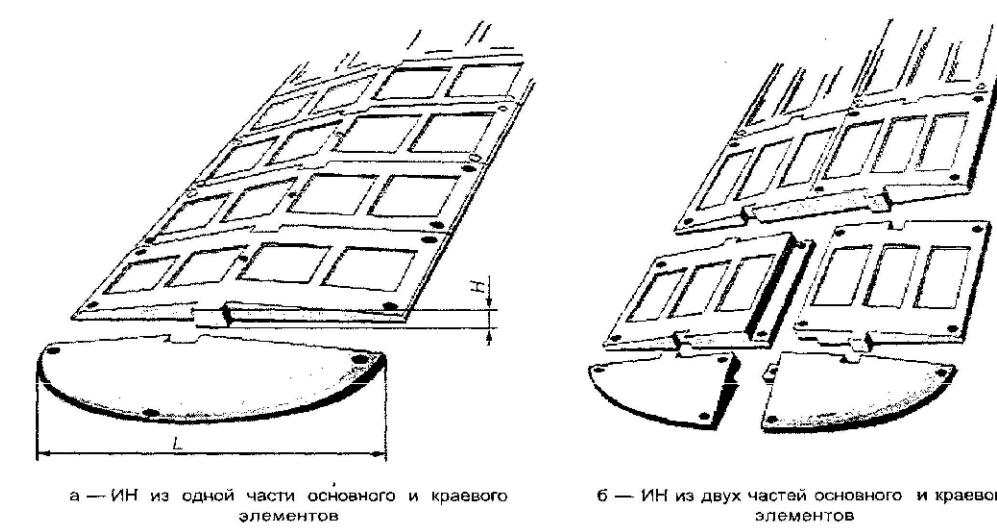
Конструкция сборно-разборной искусственной дорожной неровности
